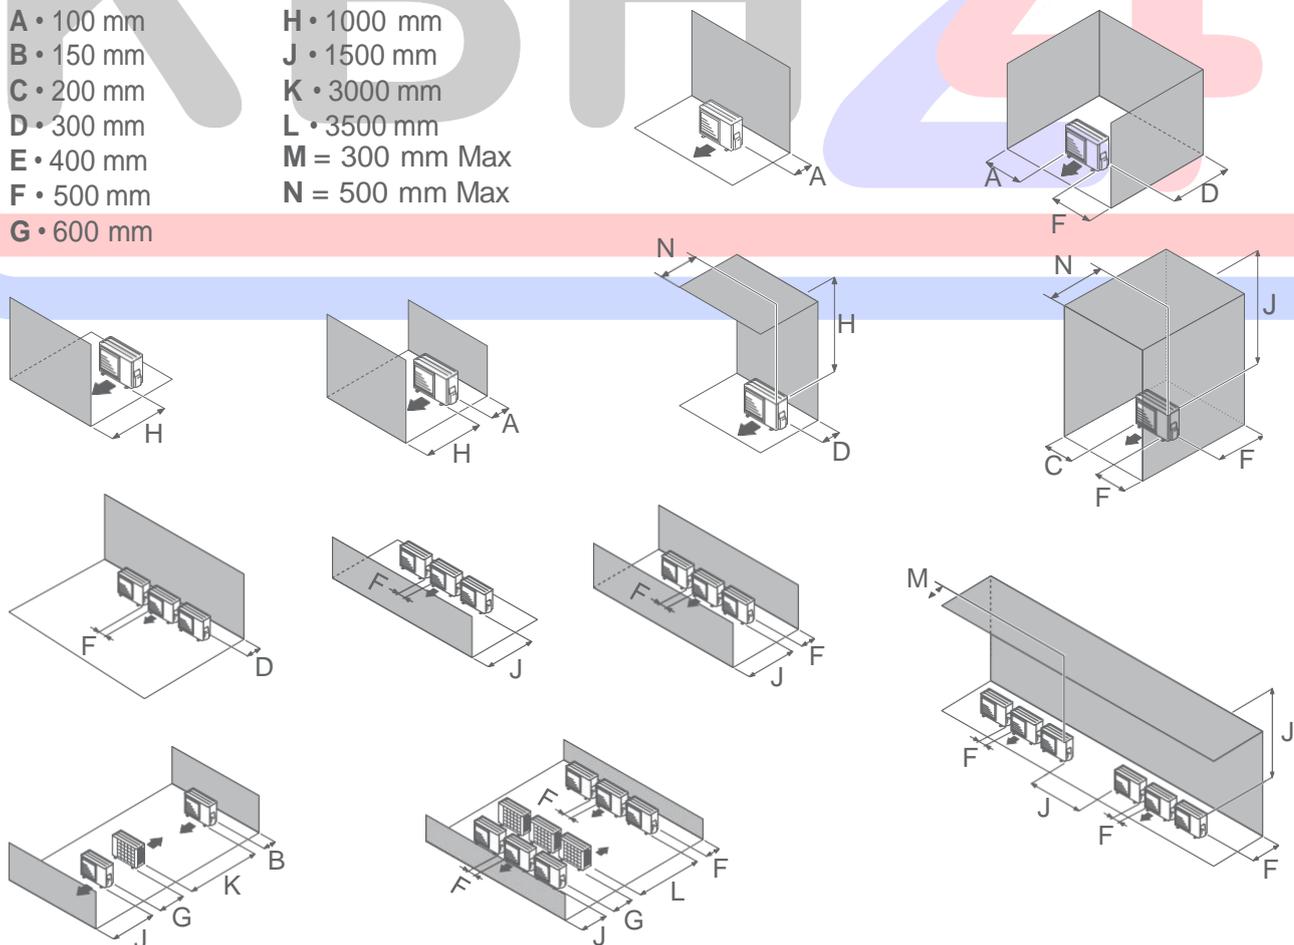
Mindestinstallationsabstände rund um das Außengerät
